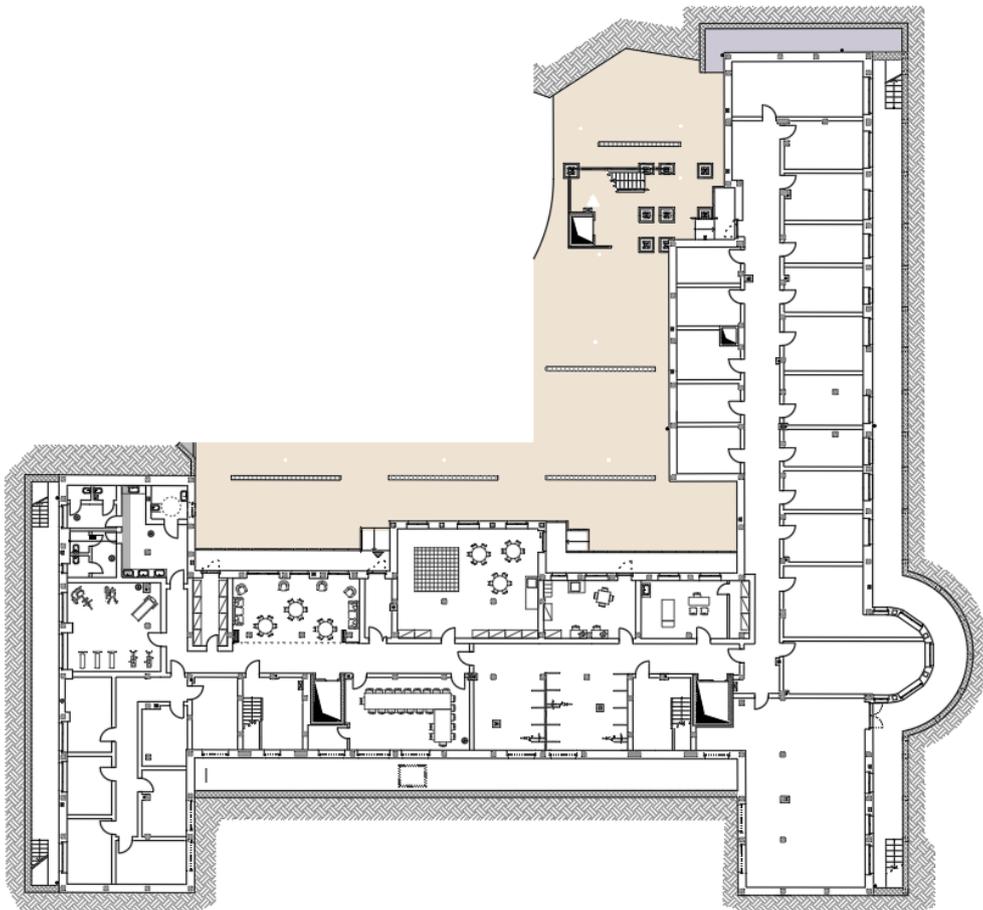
Planimetria generale piano seminterrato con spazi comuni arredati.
